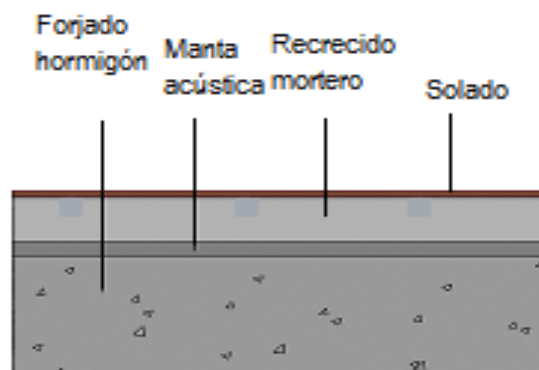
Esquema colocación del sistema de manta acústica más recredido de mortero (Fuente: elaboración propia)
